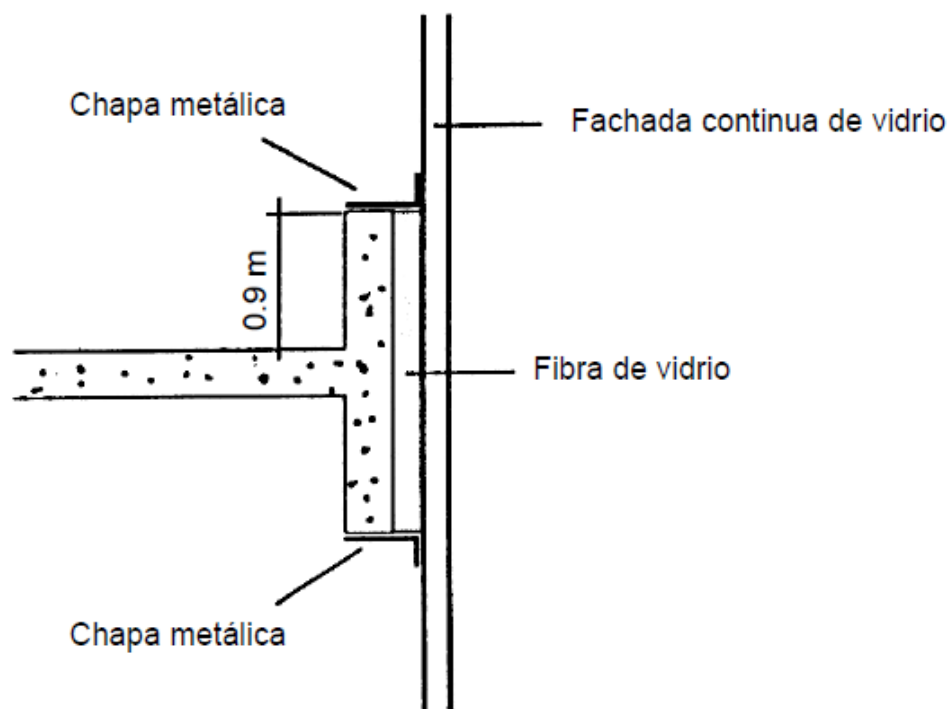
Ejemplo de aislamiento entre pisos cuando se dispone de fachada continua de vidrio
